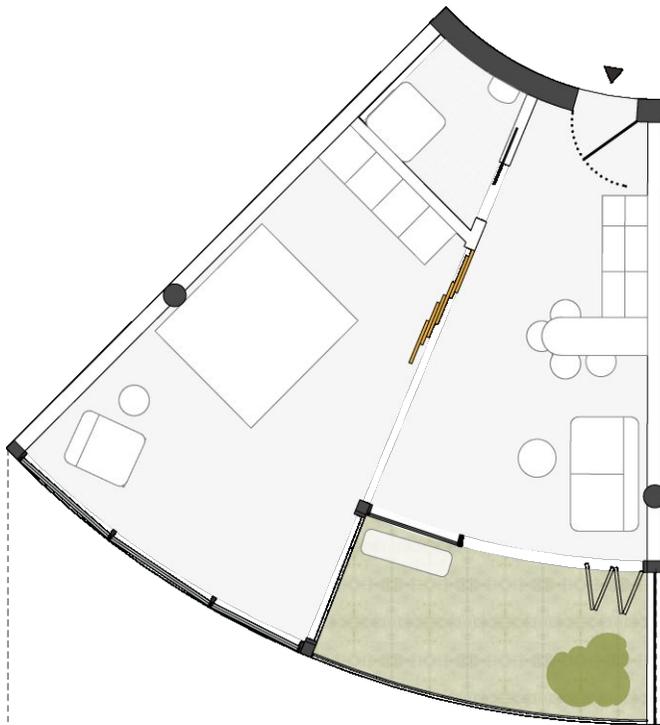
Grundriss Wohnung Typ A.c, halboffen
